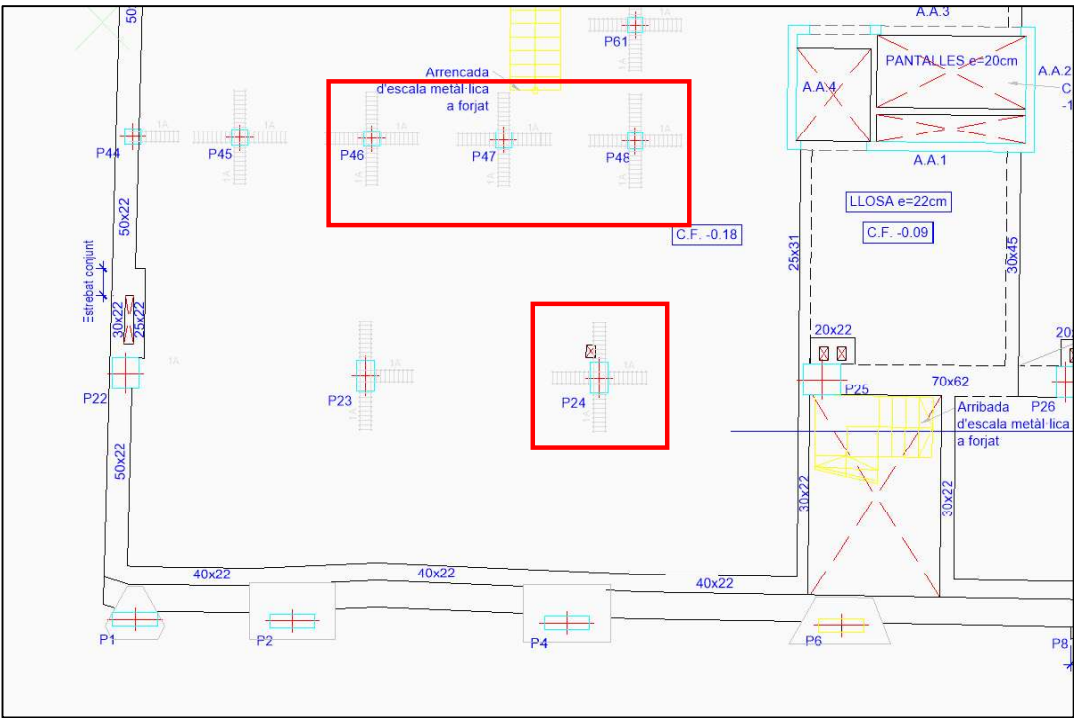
Disposición en planta de los pilares afectados por bajas resistencias en el hormigón
